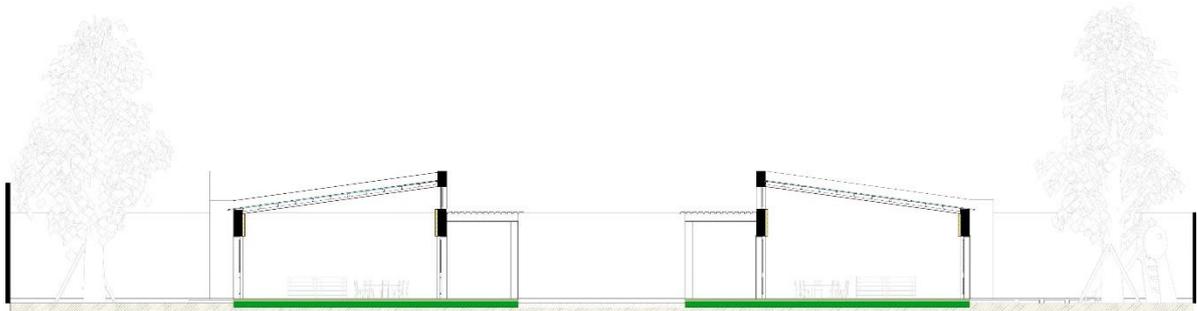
Anteproyecto arquitectónico: remodelación del edificio existente – Corte transversal 2.
